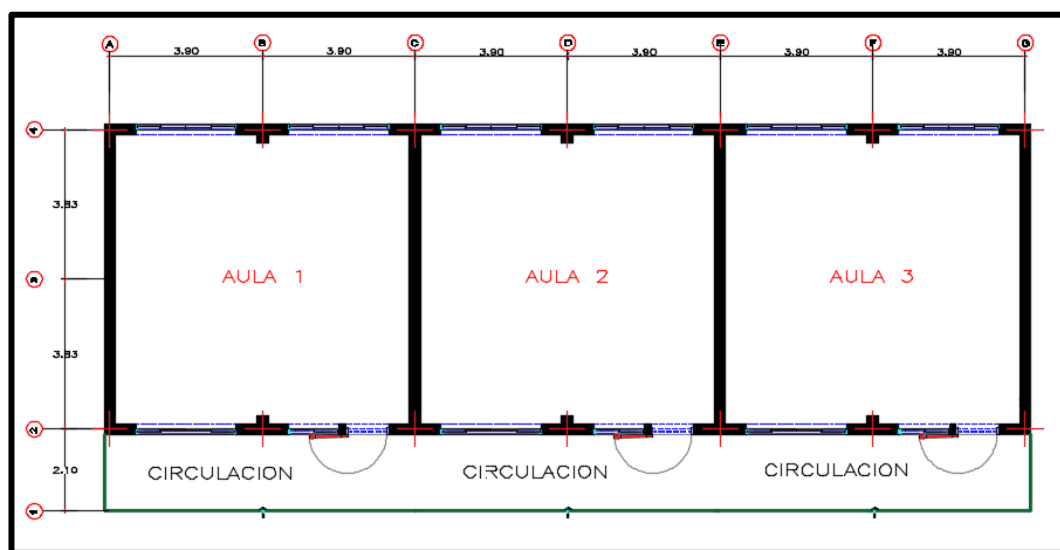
Plano de Arquitectura en el Software AutoCAD 2015.
